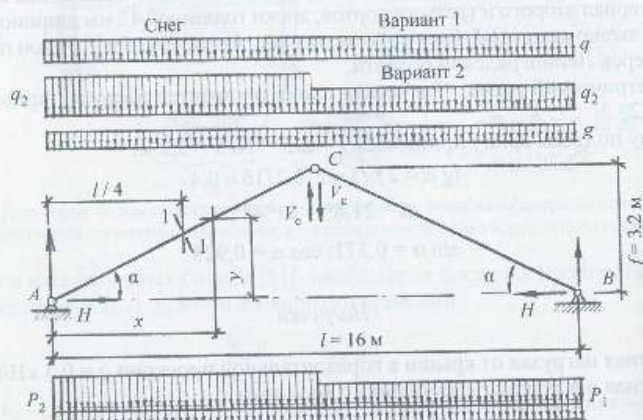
Расчетная схема арки из прямолинейных элементов и силовые воздействия на нее
